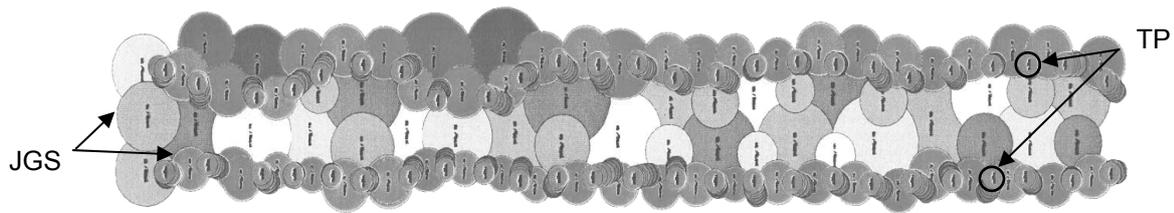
Grundriss Sandwichwand (Ist-Situation)
